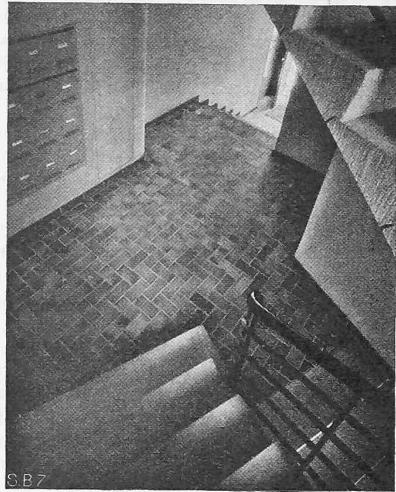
Treppenhaus an der Kalchbühlstrasse, vergleiche untenstehenden Erdgeschoss-Grundriss.
